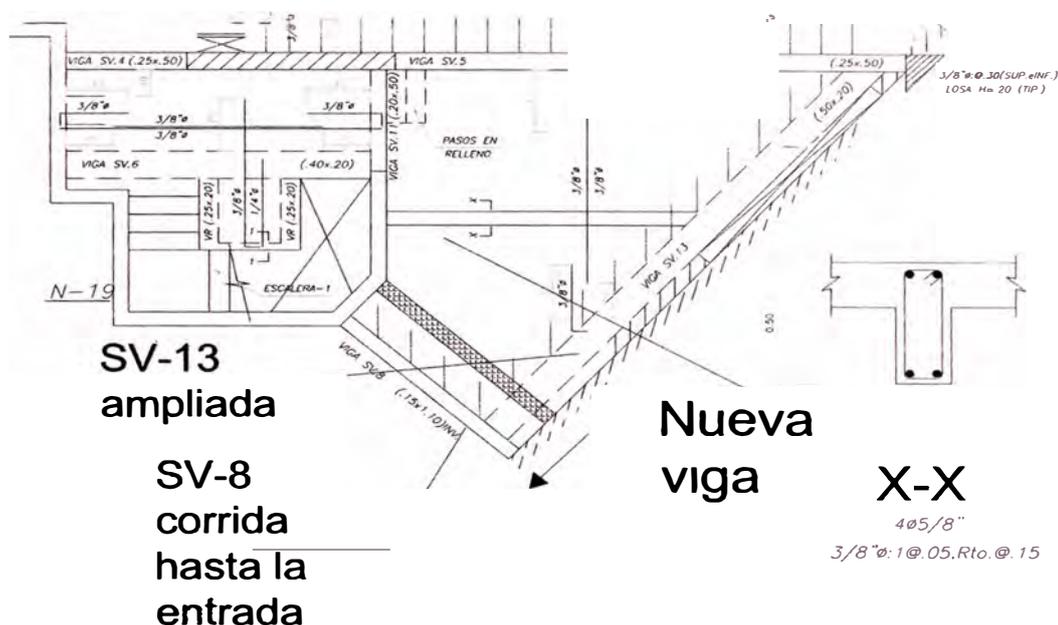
Detalle en Planta de voladizo en entrada a sótano. Ver E-04, Sótano
